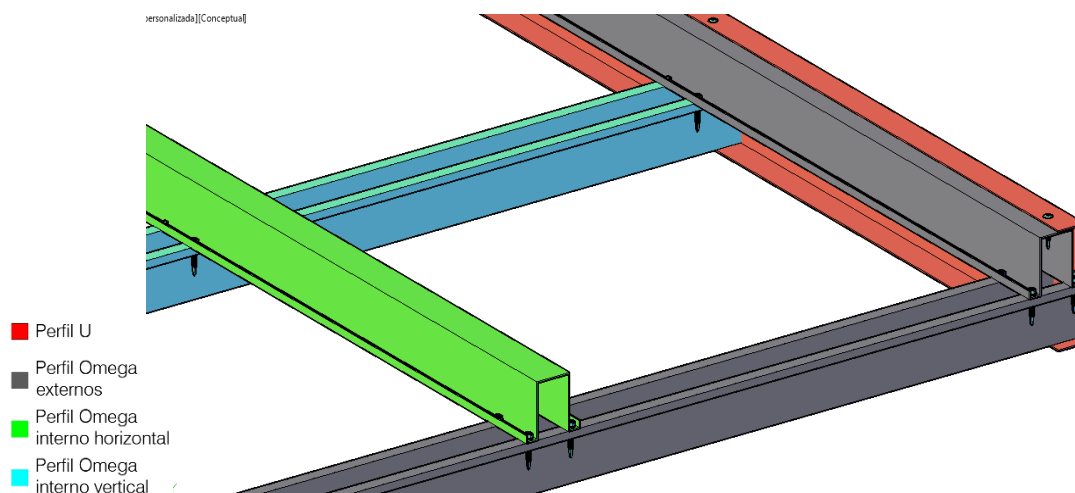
Isometría Detalle de Unión del Panel Doble Perfiles Omega y U
